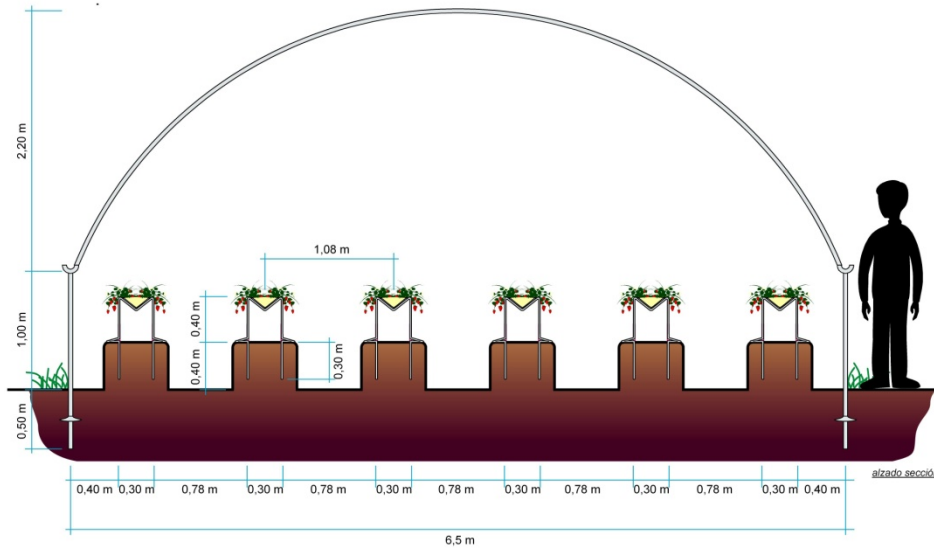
Vista frontal de diferentes disposiciones de las líneas en el túnel
